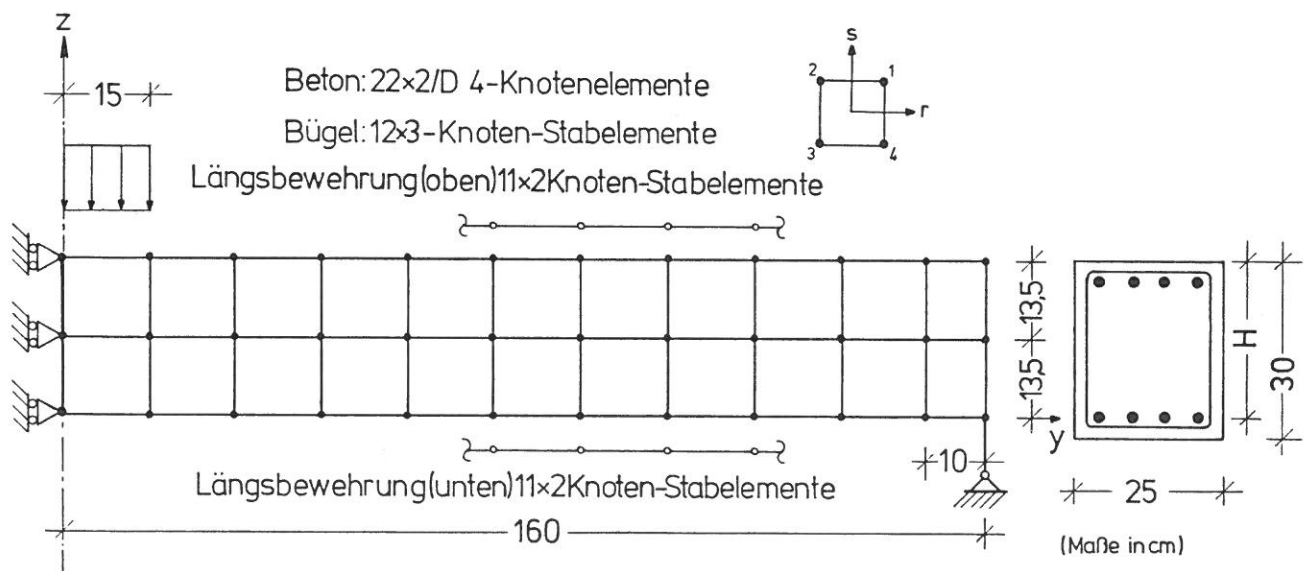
Abbildung eines Stahlbetonbalkens auf ein Scheibenmodell /3/
